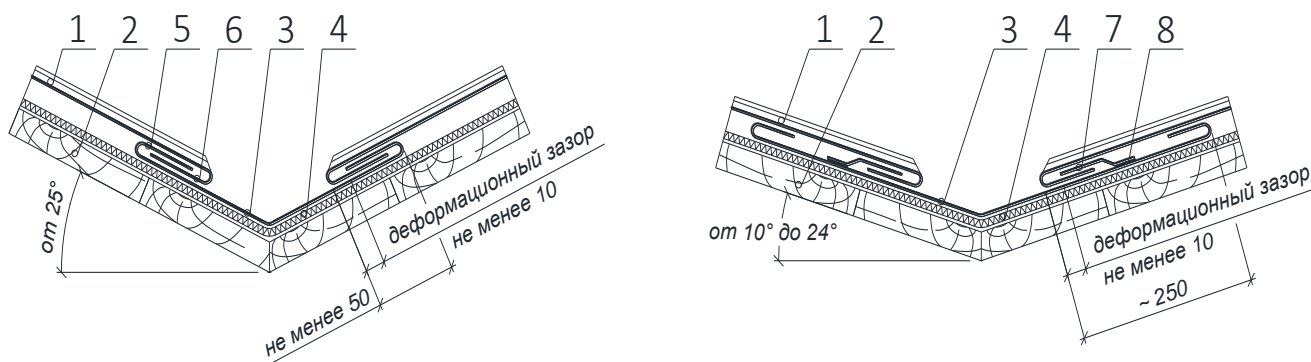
Водоотводящий желоб в ендове на фальцевой кровле:
